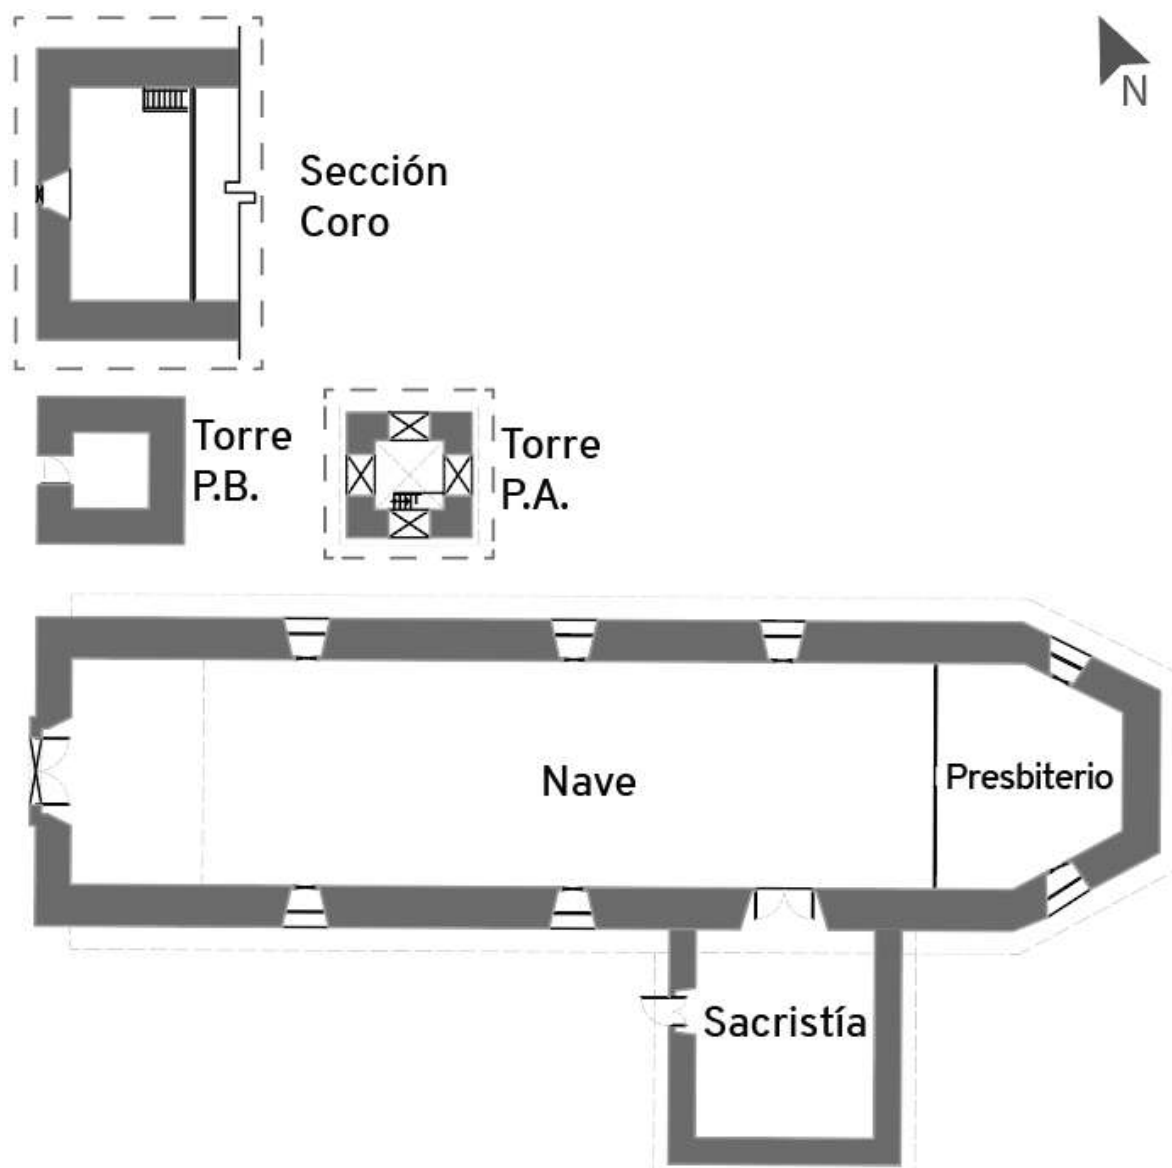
Planta de etapa constructiva de finales del siglo XVIII. Elaboración propia.
